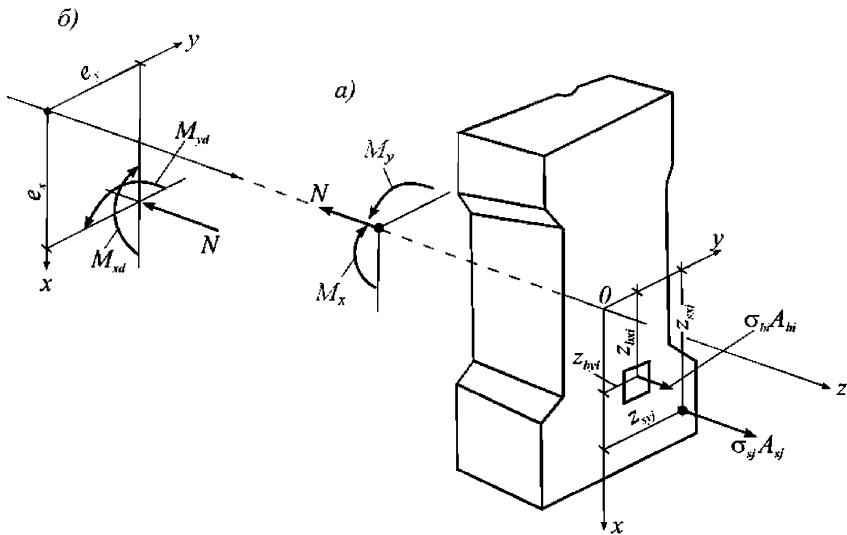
Расчетная схема нормального сечения железобетонного элемента
